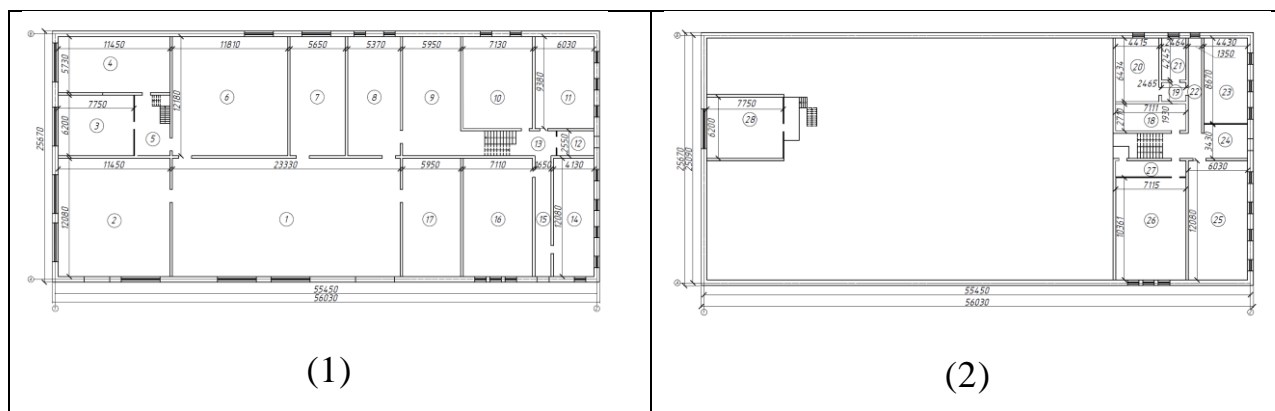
План существующего здания: план первого этажа (1); план второго этажа (2)
